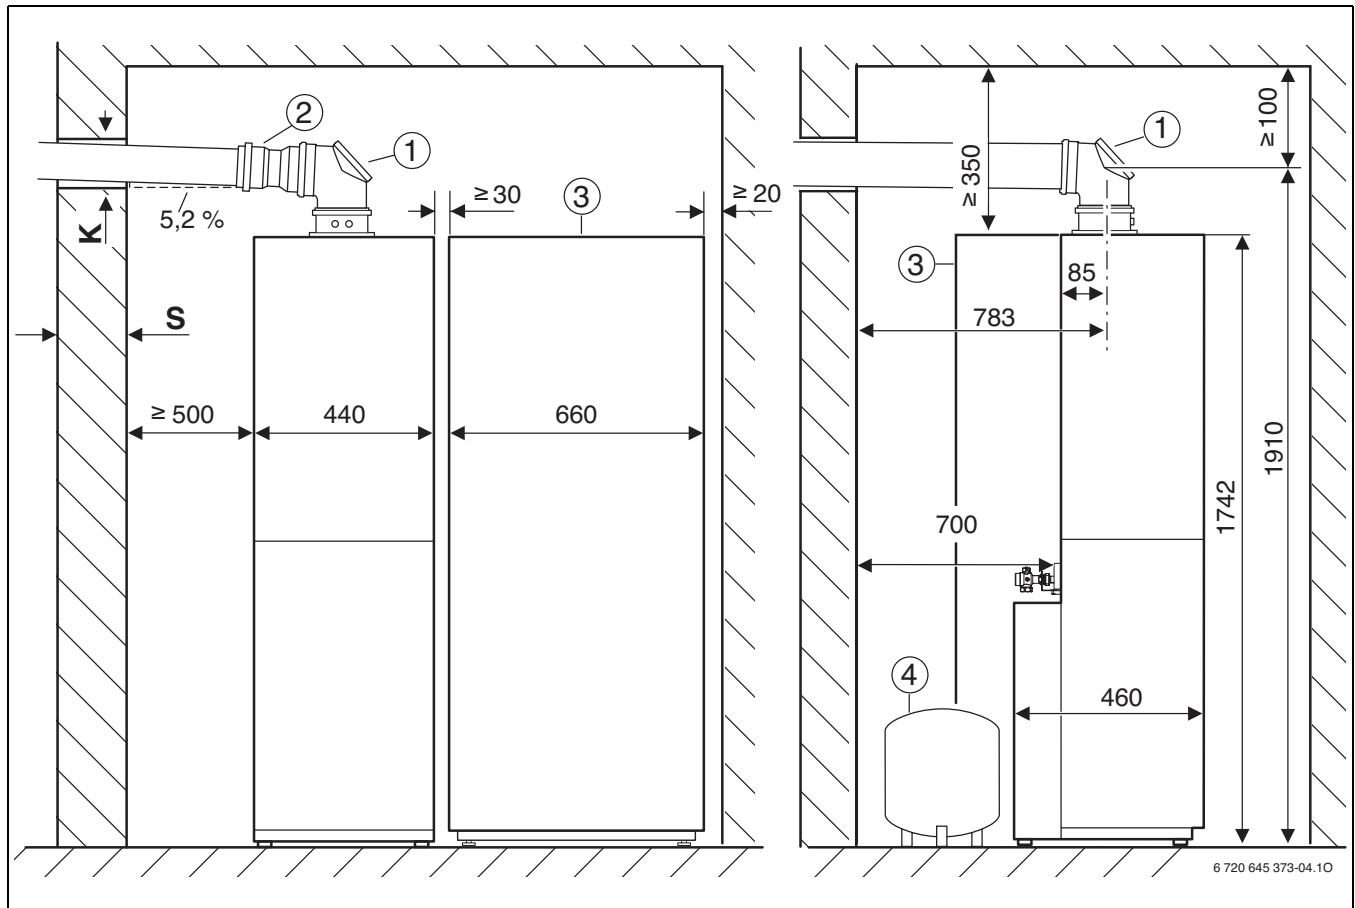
Abgasführung Ø 80/125 mm, Ø 80 mm oder Ø 60/100 mm
